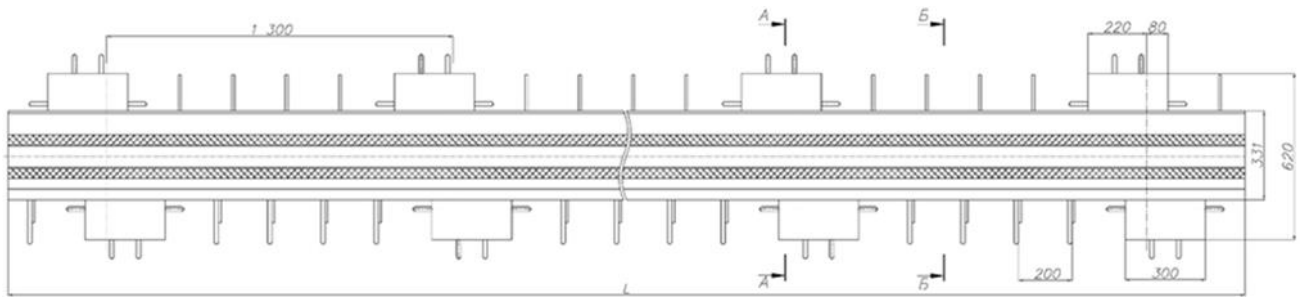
Пример МПДШ со сварными траверсами (вид сверху)
